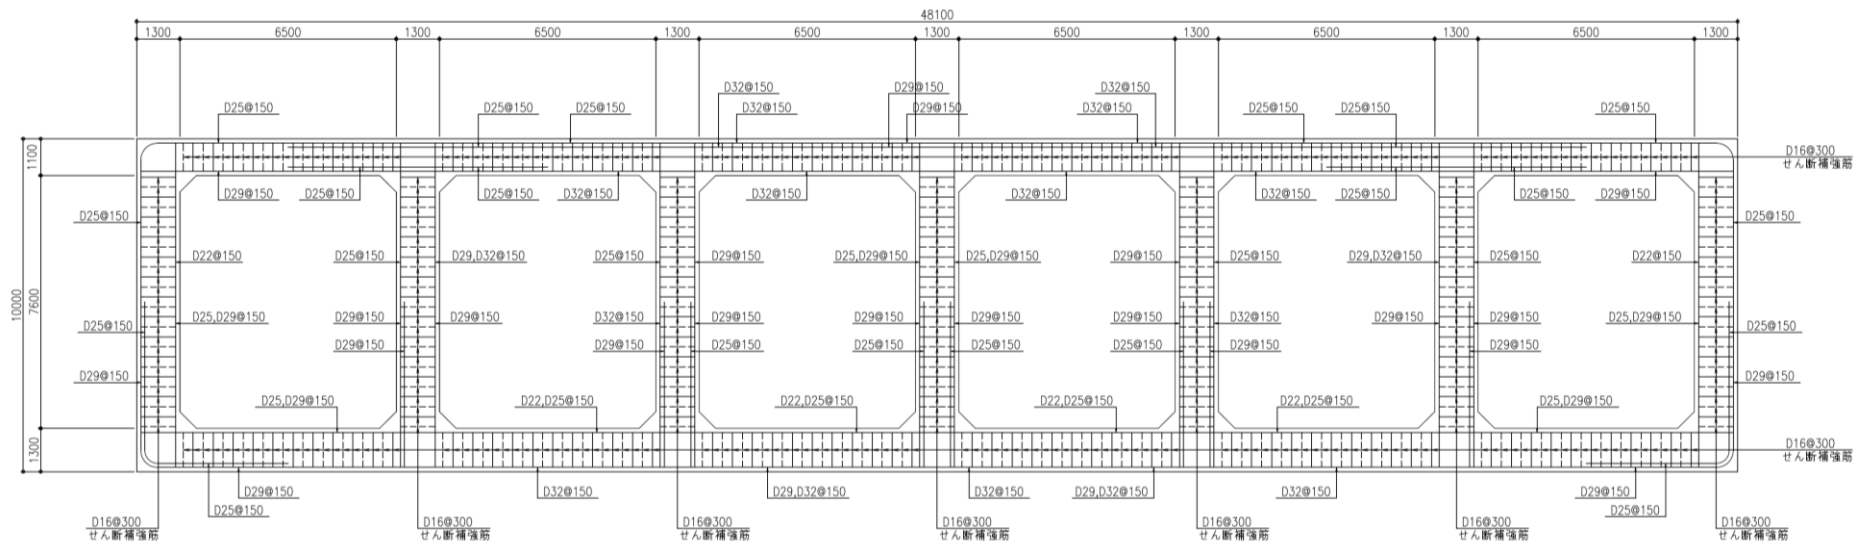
スクリーン室の概略配筋図 (A-A断面)
